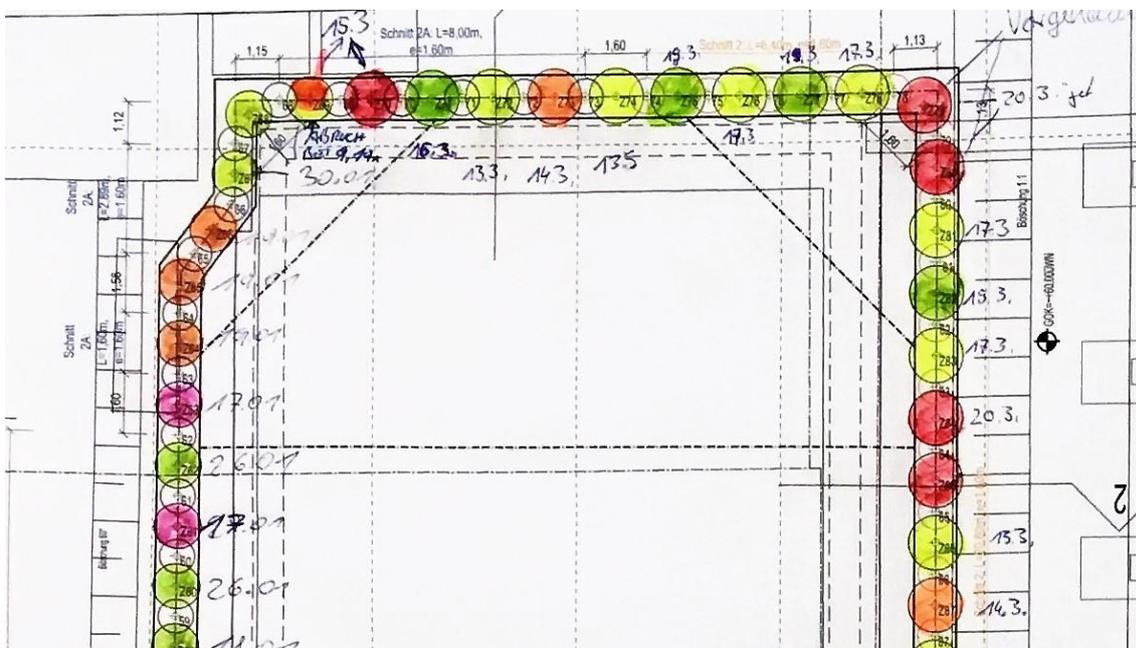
Markierung hergestellter DSV-Elemente im Ausführungsplan (Ausschnitt)
